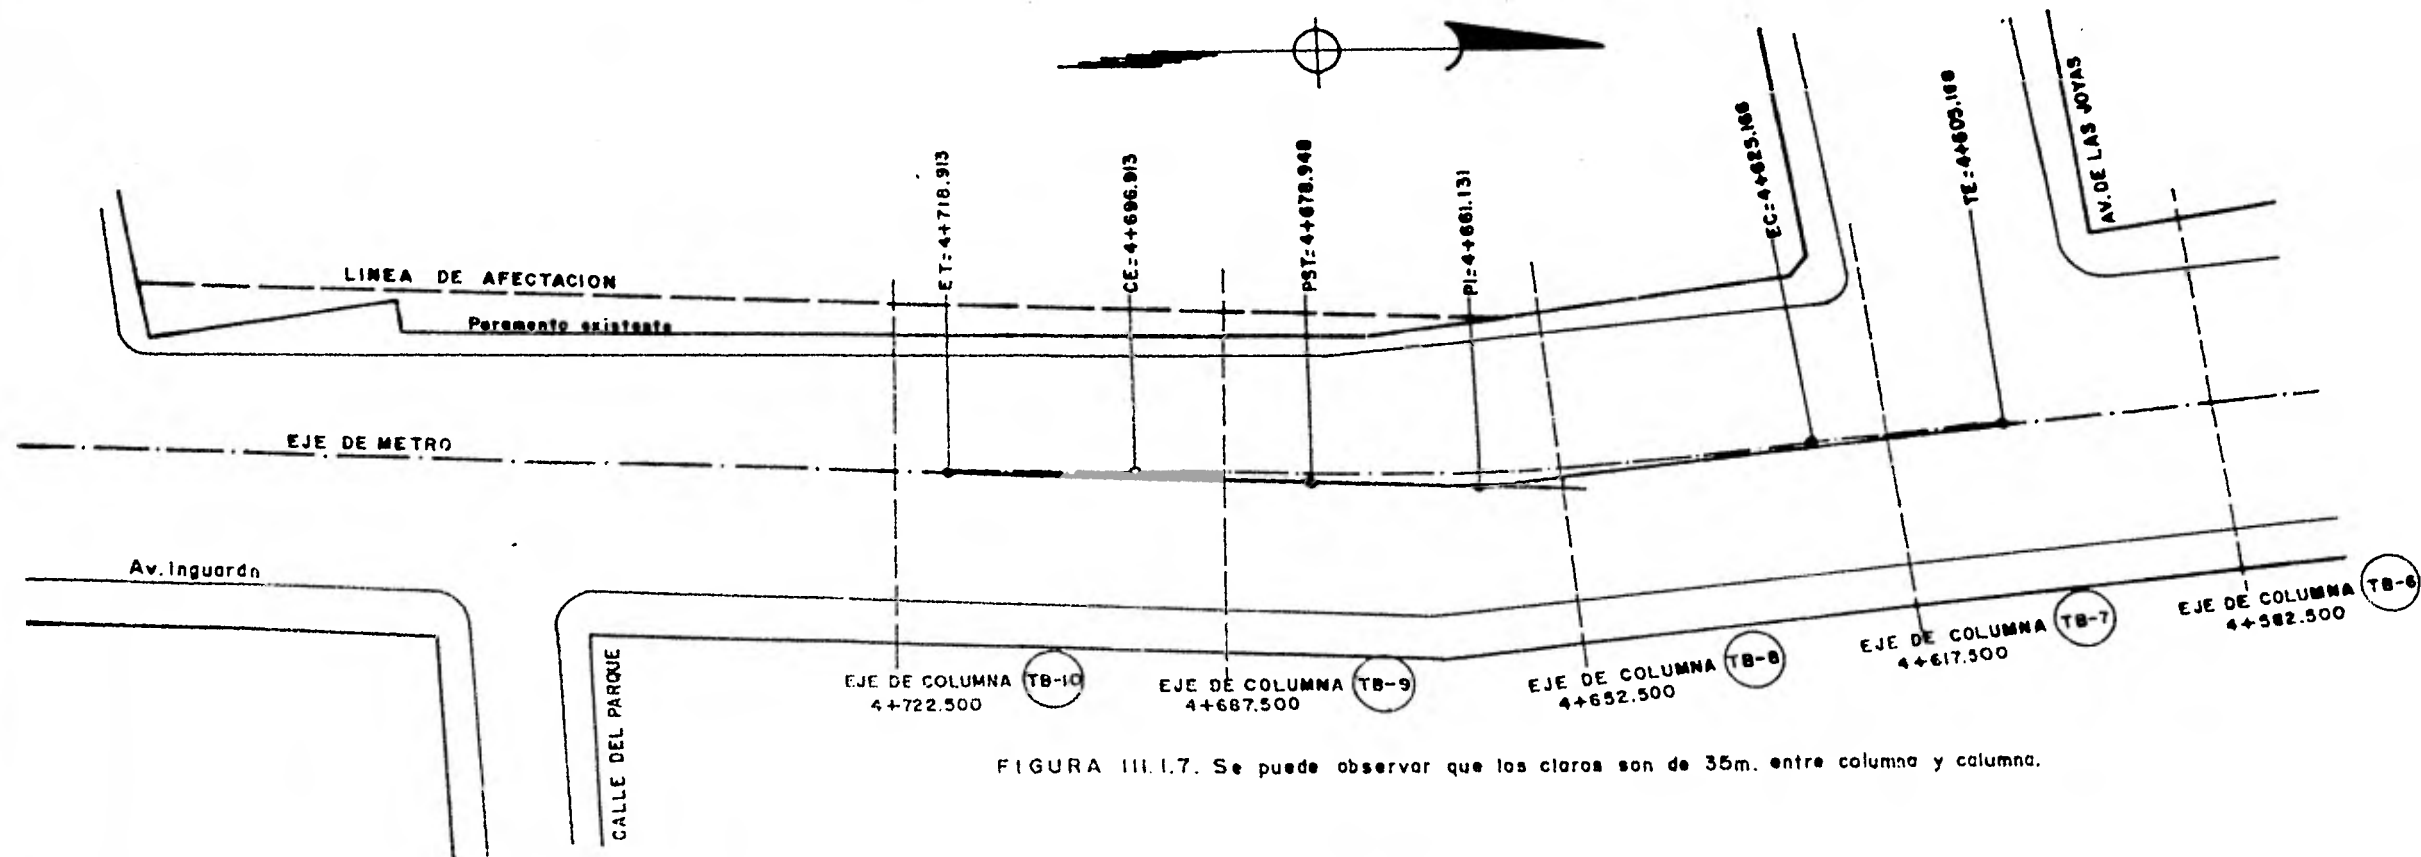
Se puede observar que los claros son de 35m. entre columna y columna.
